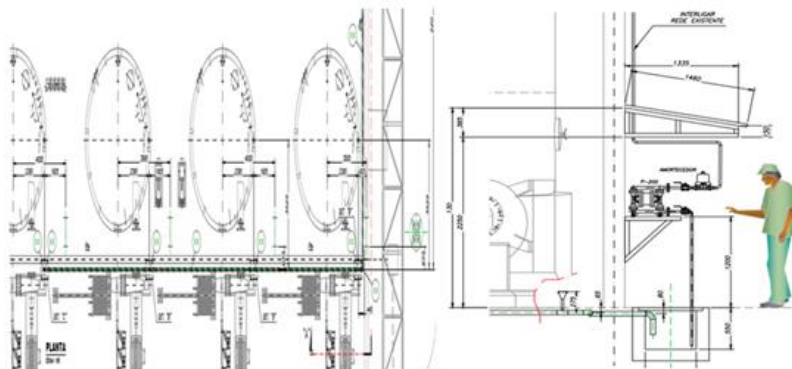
Detalhamento do projeto- Planta do circuito fechado
